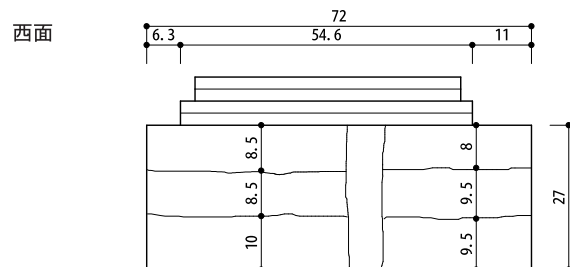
第一書庫北室 独立基礎 コンクリート基礎 実測図
